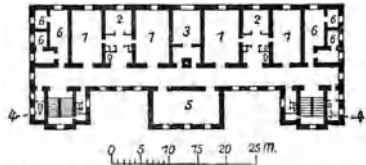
Krankenhaus: Grundriß, Korridorssystem.
